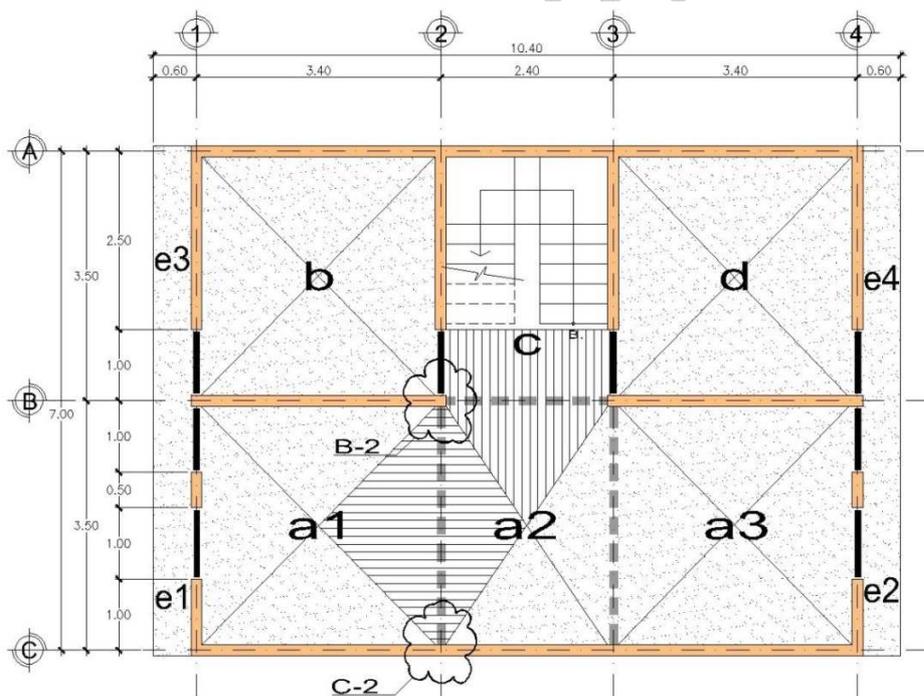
Planta para resolver las vigas del Ejemplo 1 se ilustran las áreas tributarias de las dos vigas que se diseñan en el texto.
